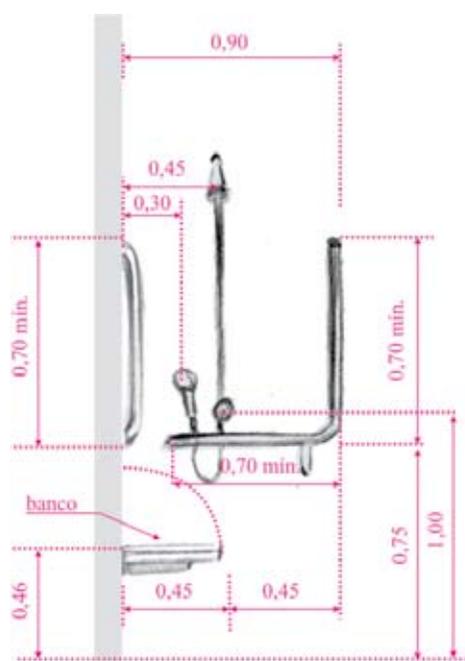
Boxe para chuveiro com barra de apoio em L - Vista frontal
